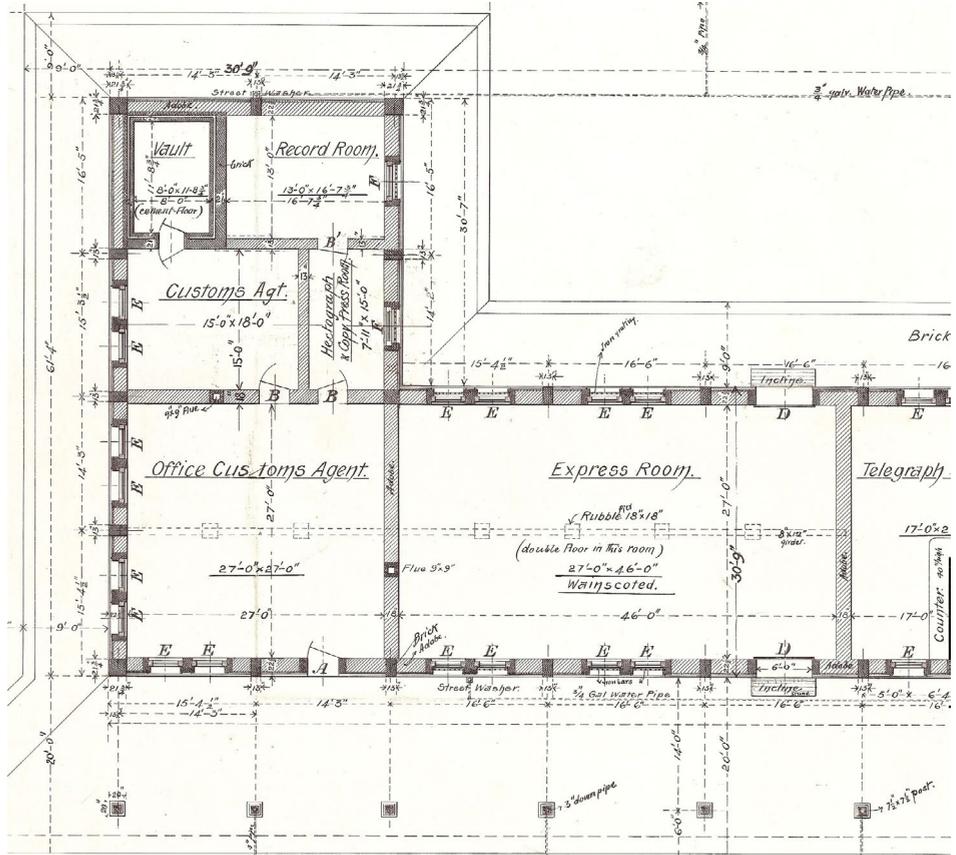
Detalle de planta arquitectónica de la estación del Ferrocarril Central Mexicano.
